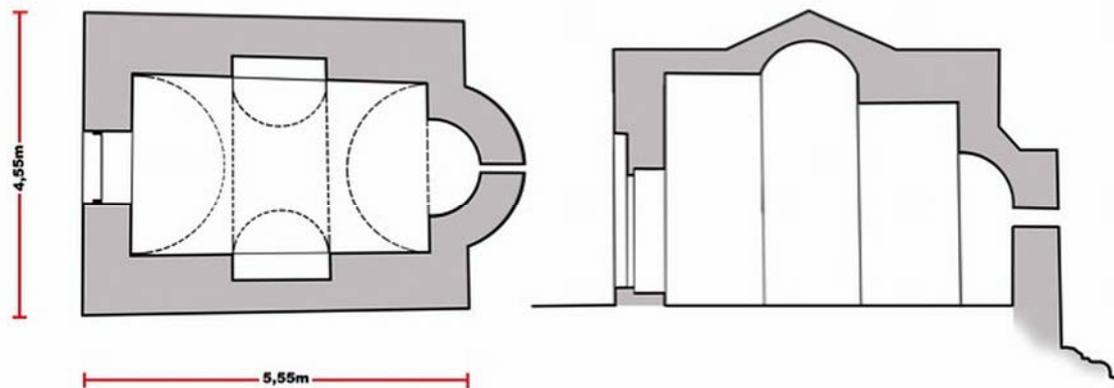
Plan b: Mouri, Hagios Nikolaos, Grundriß und Schnitt
